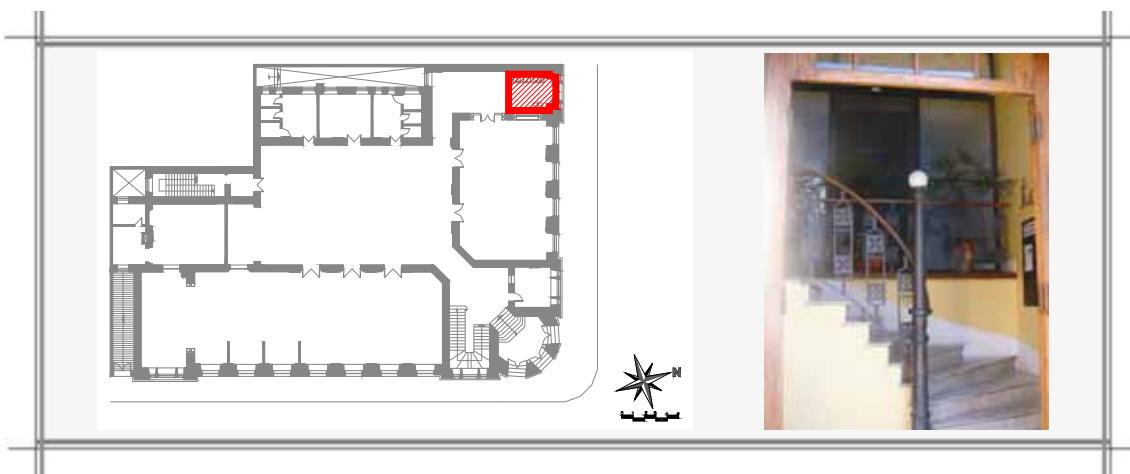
Planta Baixa 1ºPav, com a localização do Acesso. Desenho: Cristiane Müller
